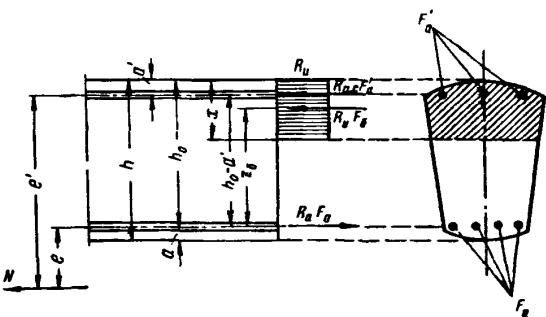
Схема расположения усилий и эпюра напряжений в поперечном сечении внецентренно растянутого с большим эксцентрикитетом железобетонного элемента при расчете его на прочность
